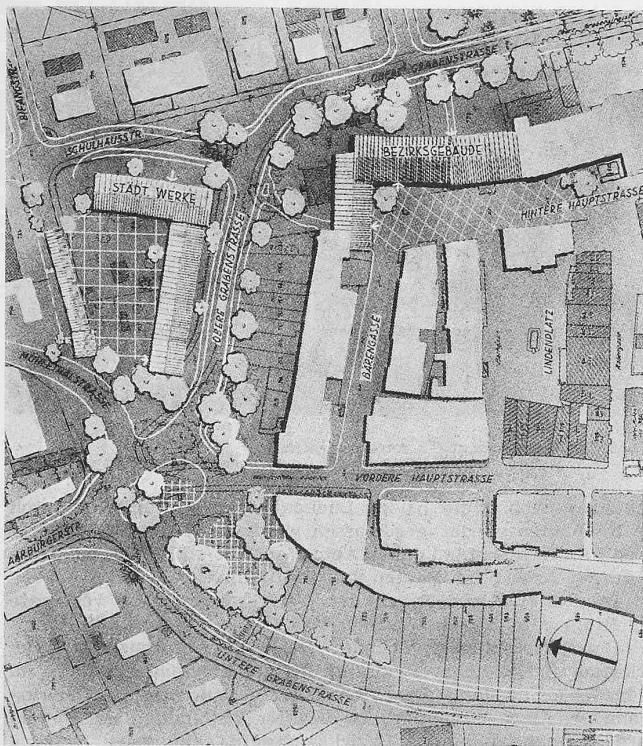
Ausschnitt aus dem Plan der Gemeinde Zofingen. Maßstab 1:7500
